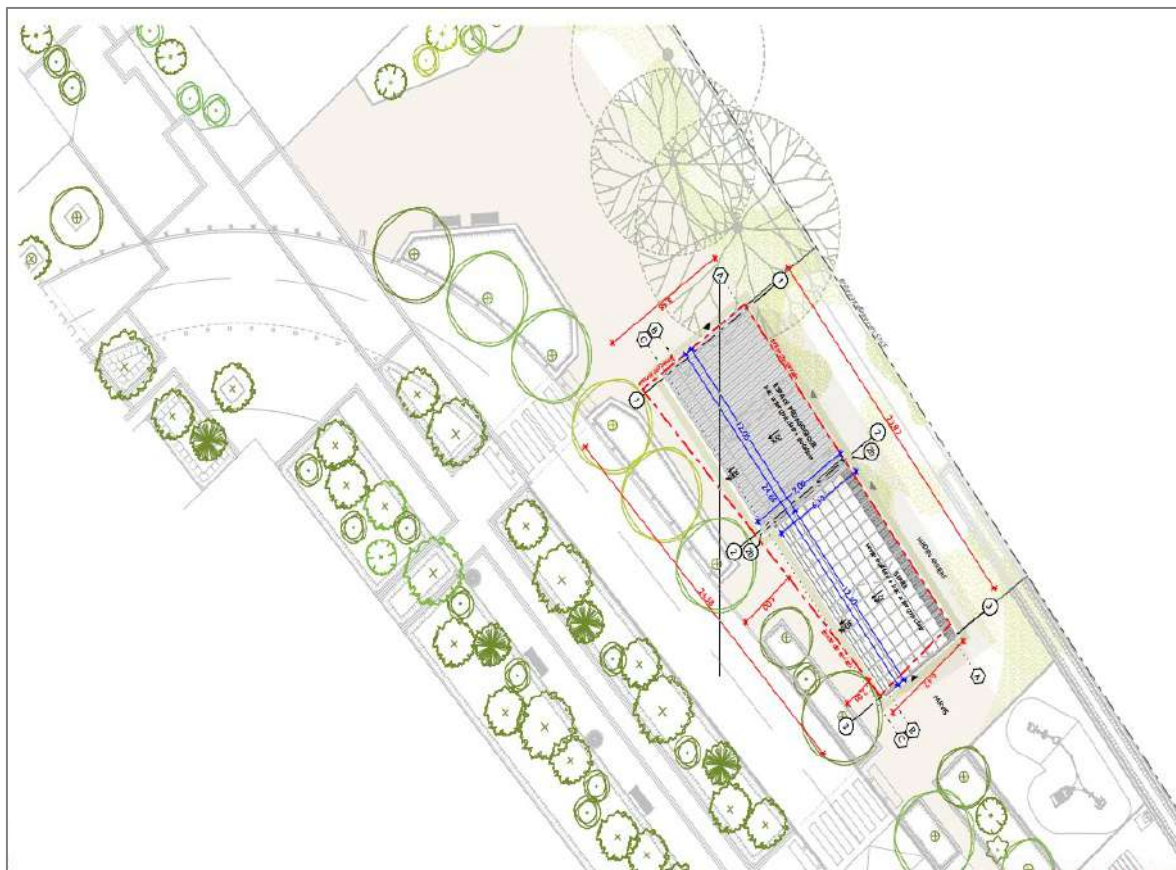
Plan de masse (Source : maitrise d'œuvre)
